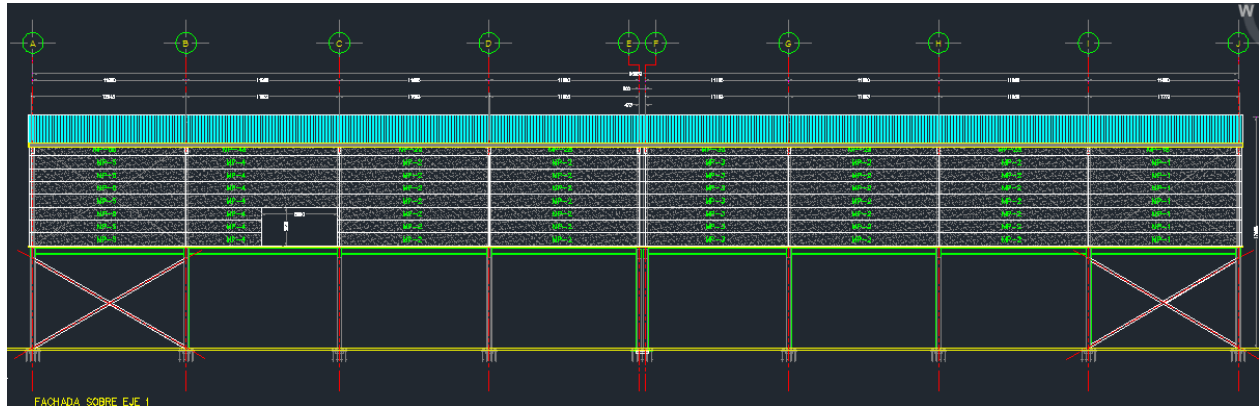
Fachada sobre el eje 1 para la fachada de eje A.
